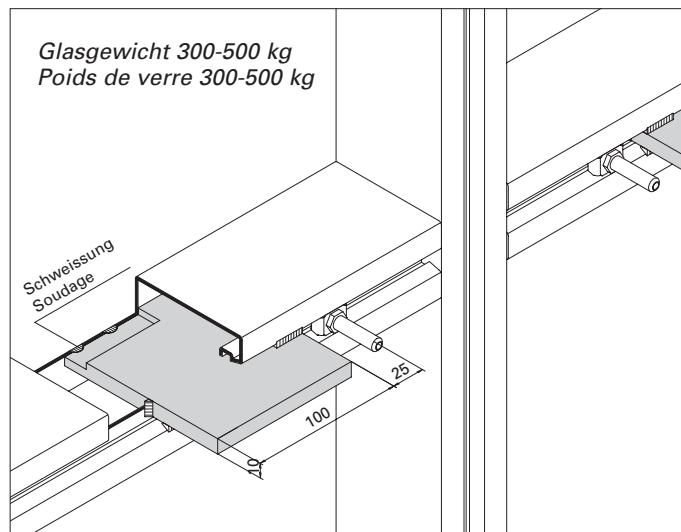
Spezial-Glasaufage (Glasgewicht 300-500 kg) gefertigt aus Flachstahl 100x10 mm, im Bereich VISS-Nute und Riegel-Rückseite eingeschweißt (siehe Abb. 27).
